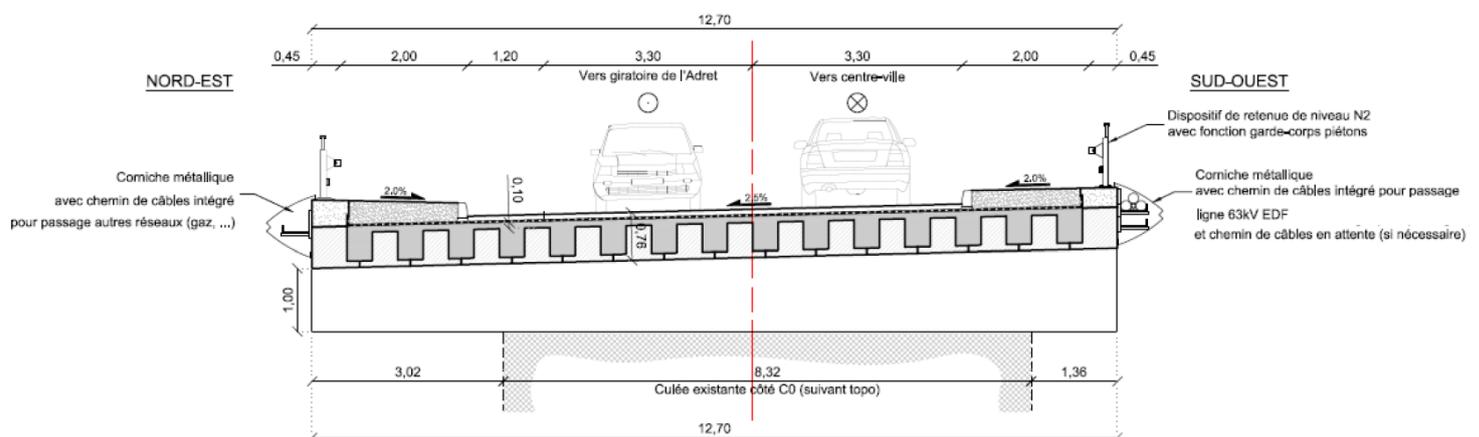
Exemple de pont en poutres inversés – Pont Adret – SCE 2021
